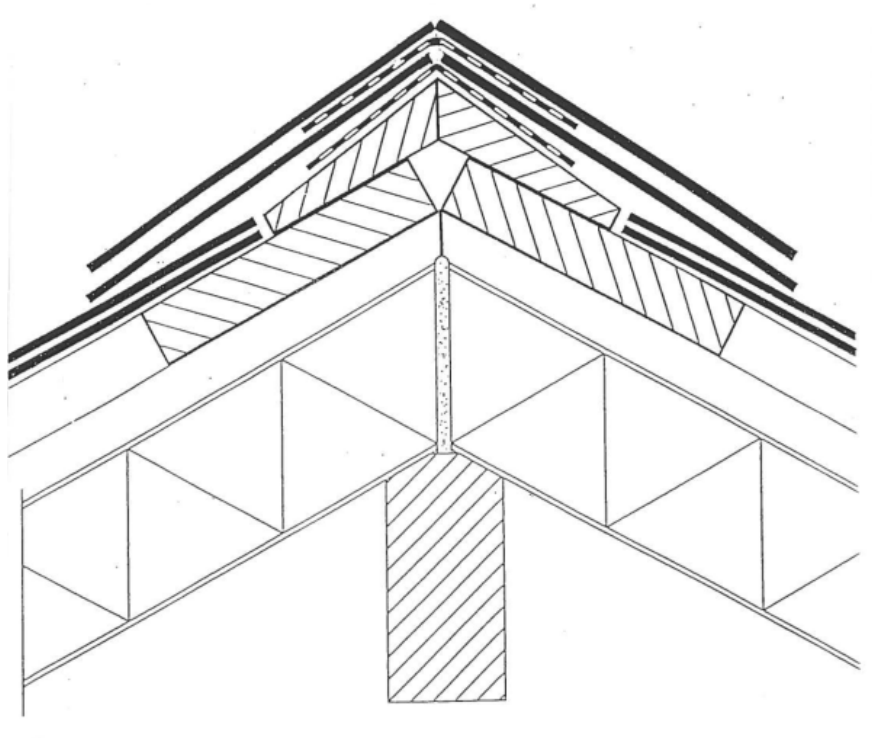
Aanzicht hoekkeperafwerking Franse hoek
